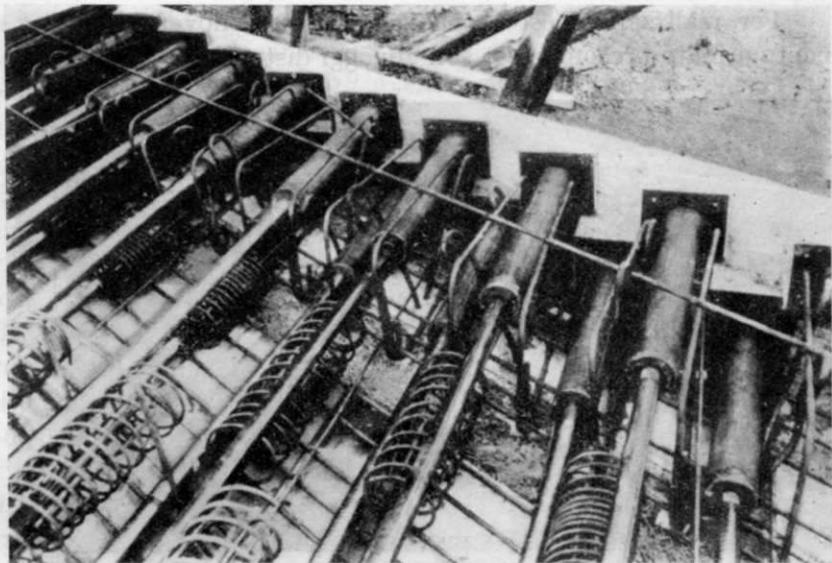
Elementi di messa in trazione in un ponte - Estremità di trazione e di ancoraggio.
